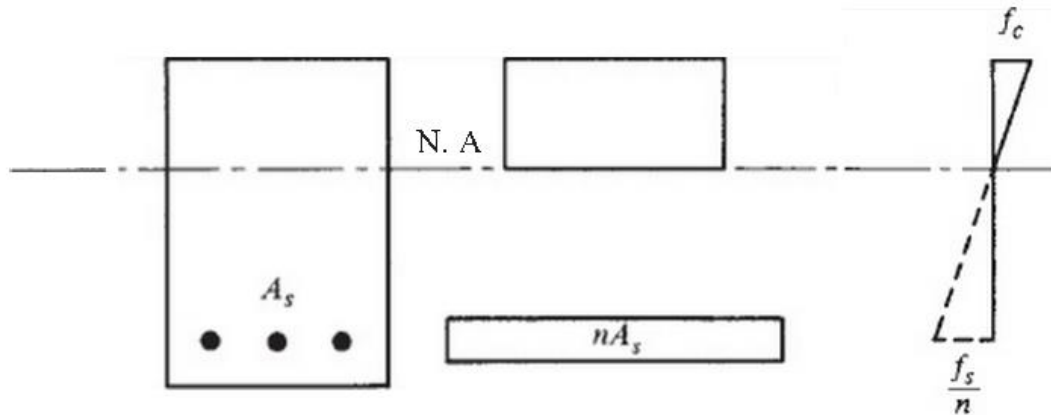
, Esfuerzo elástico: concreto agrietado
